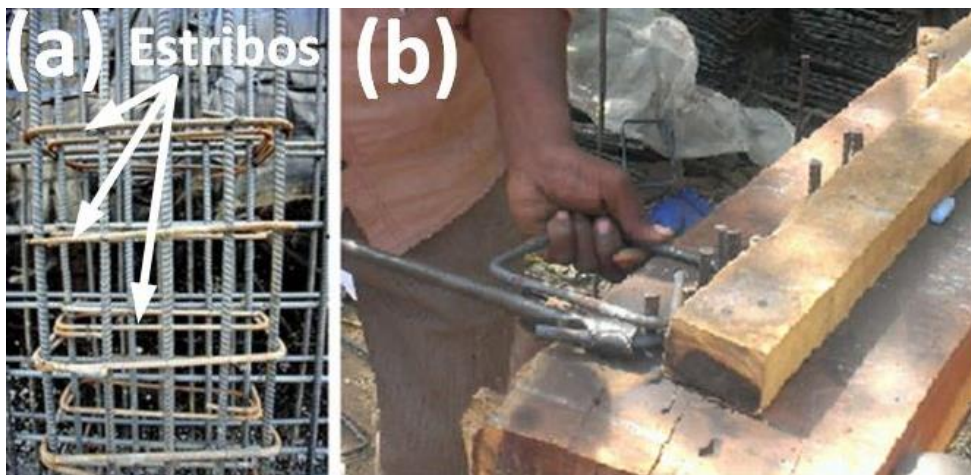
Estribos: (a) Estructura Tridimensional para concreto armado unida mediante estribos (b) Fabricación manual de estribos
